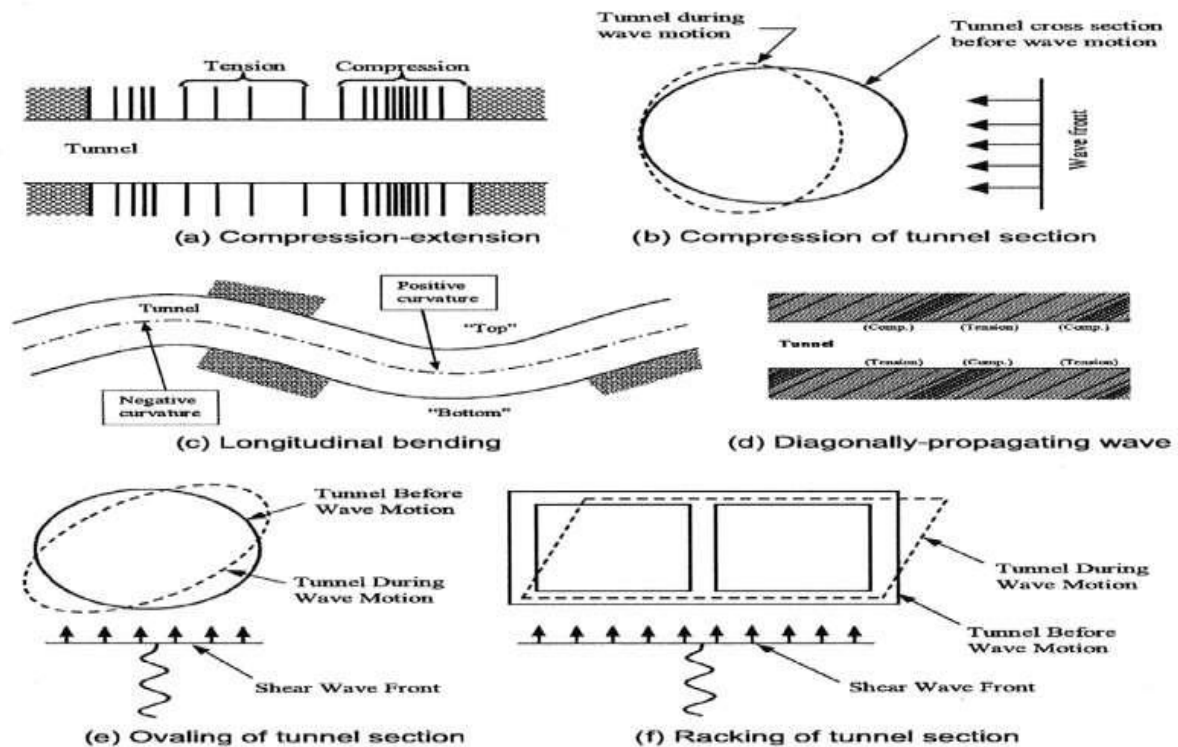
(e) Déformation ovale d'un tunnel circulaire – (f) Déformation en rayonnage d'un tunnel rectangulaire (Owen et Scholl [1981]).
